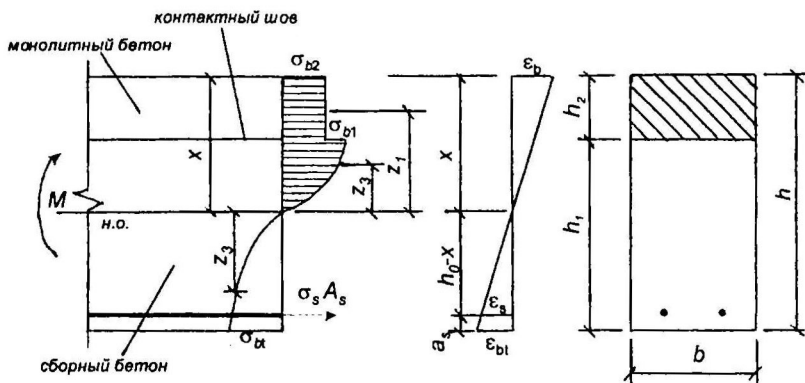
Схема усилий, эпюра напряжений и деформаций при расчете на основе аналитических диаграмм деформирования бетона и арматуры.
